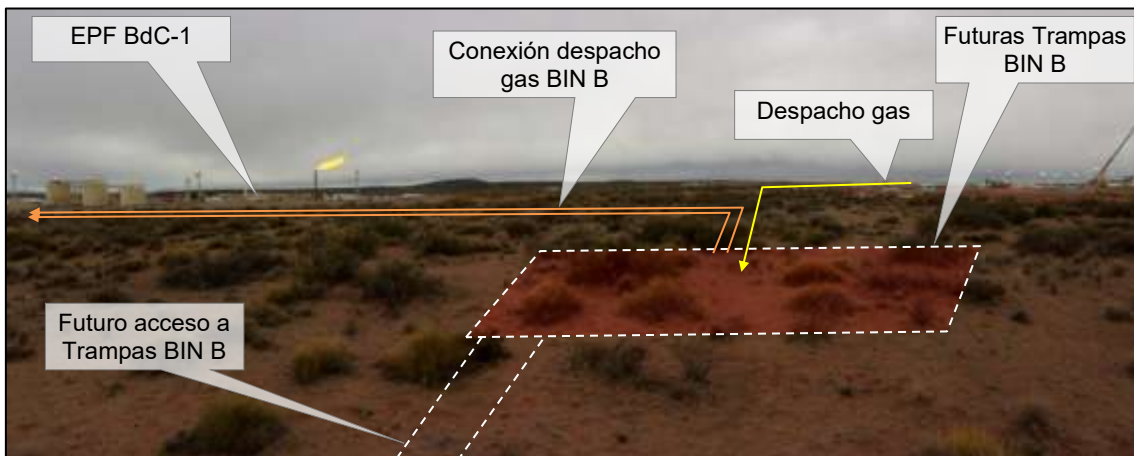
Vista en dirección Norte. Se observa el futuro acceso y predio de trampas BIN B donde culminará el ducto troncal de Despacho gas (amarillo). Además se muestran los ductos troncales de Conexión despacho gas BIN B (16"-TrampasBIN B-TrampaGas16-4026 y 16"-TrampasBIN B-TrampaGas16-4027). Coordenadas x: 5826033; y: 2487688.
